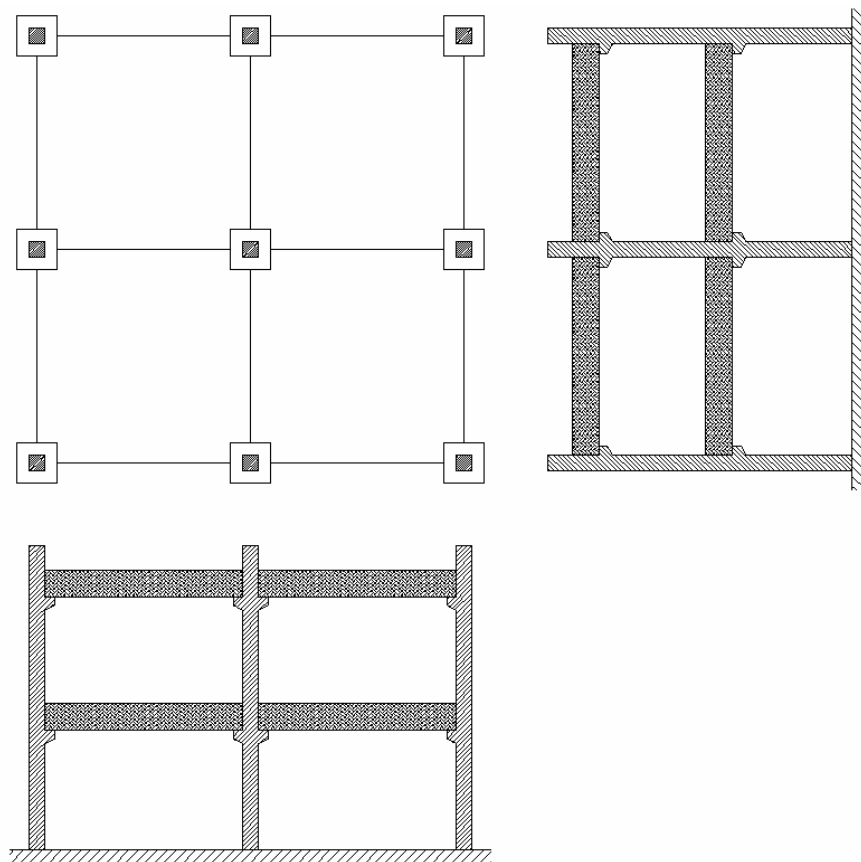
Viste in pianta e laterali dello schema portante dell'edificio analizzato
